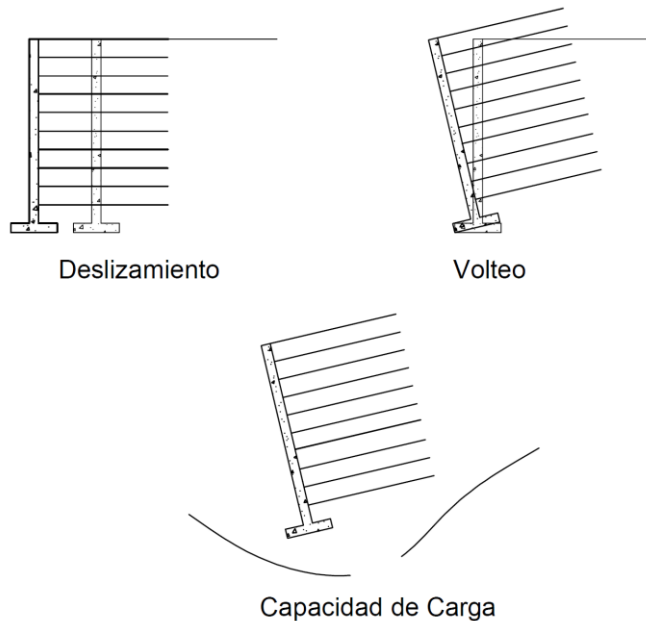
Tipos de Falla de un muro mecánicamente estabilizado
